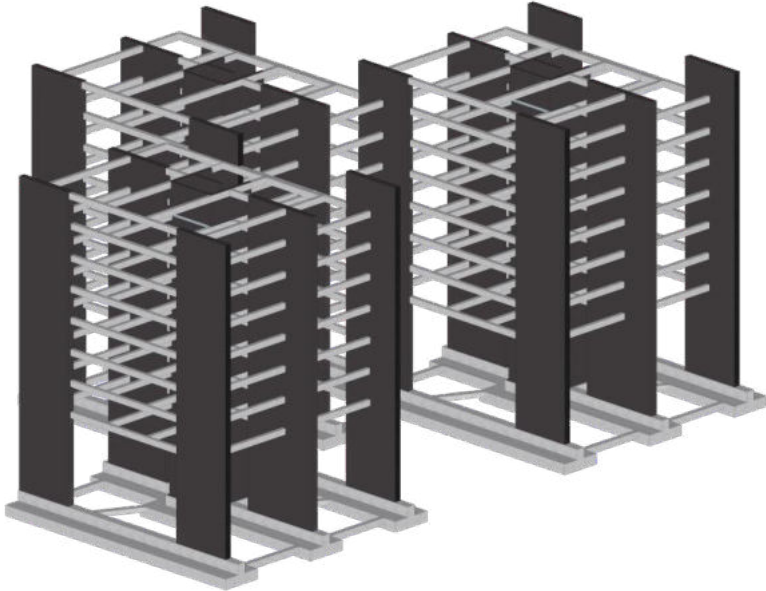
Armado cimentación, muros y vigas todo el proyecto
